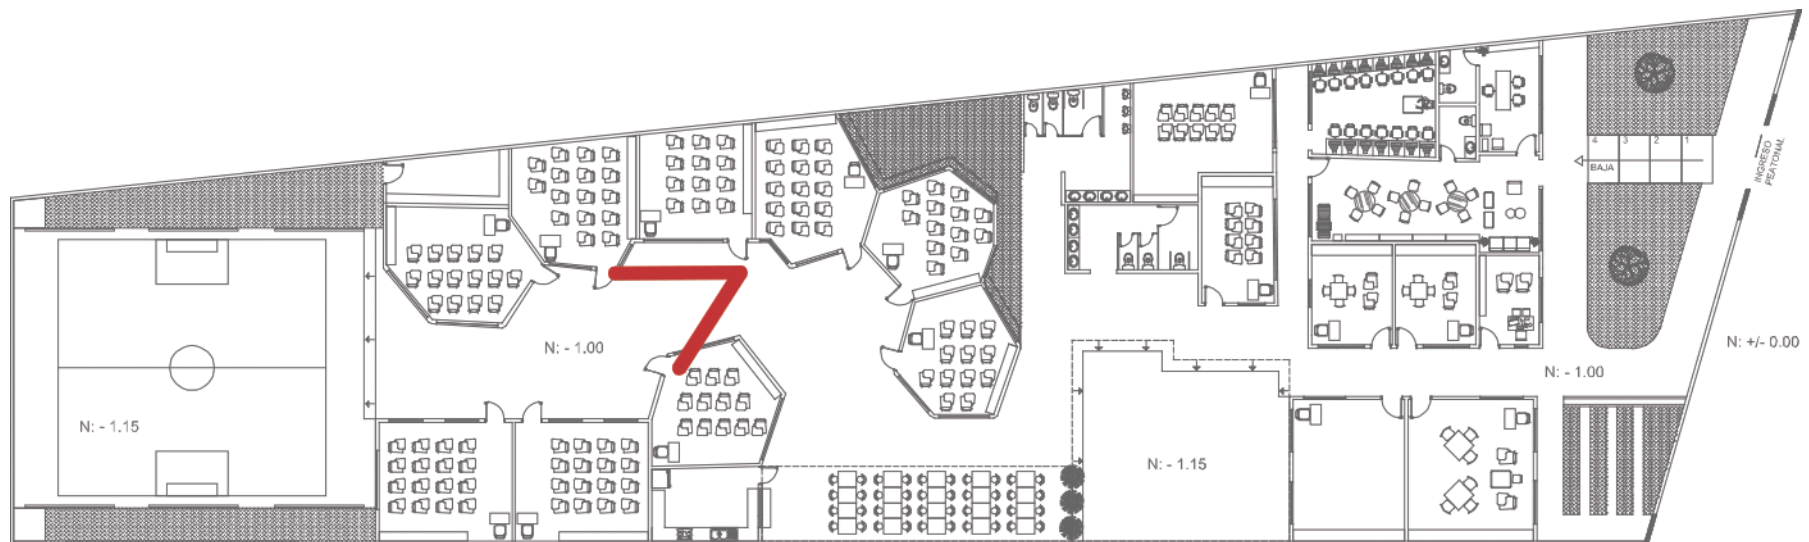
Propuesta de Rediseño. Exteriores de las Aulas Hexagonales
